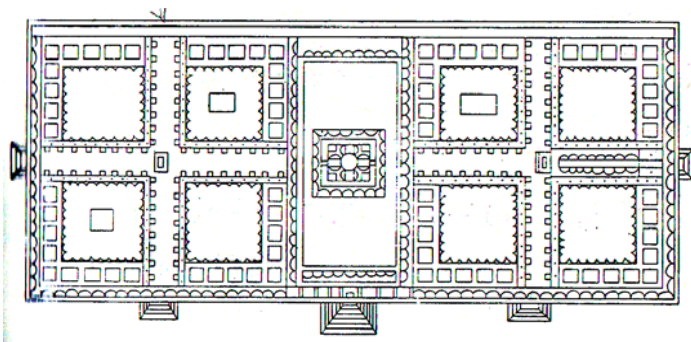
Planta do Ospedale Maggiore – Milão - Filarete, 1456
